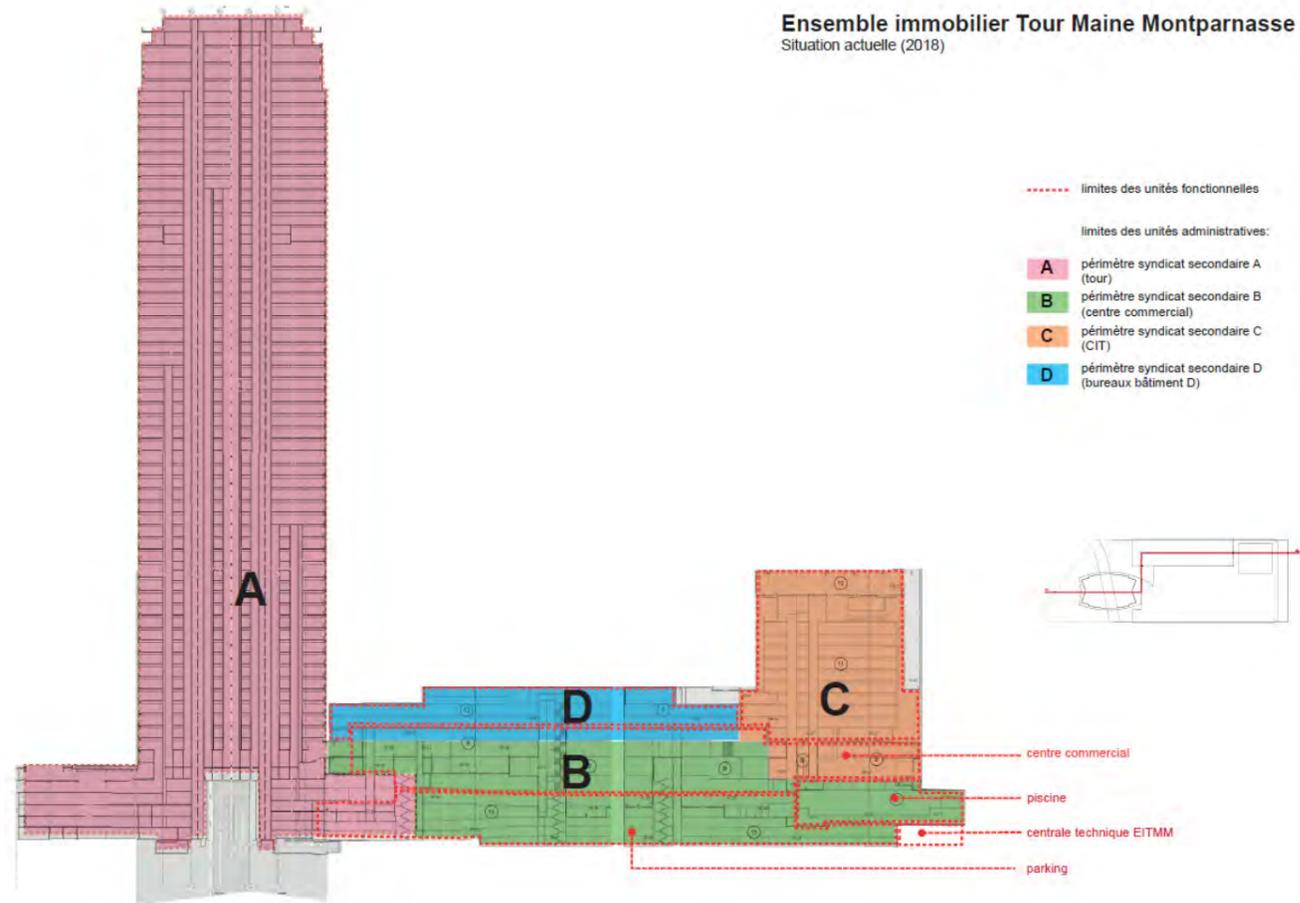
Coupe transversale de l'EITMM (NAOM)
